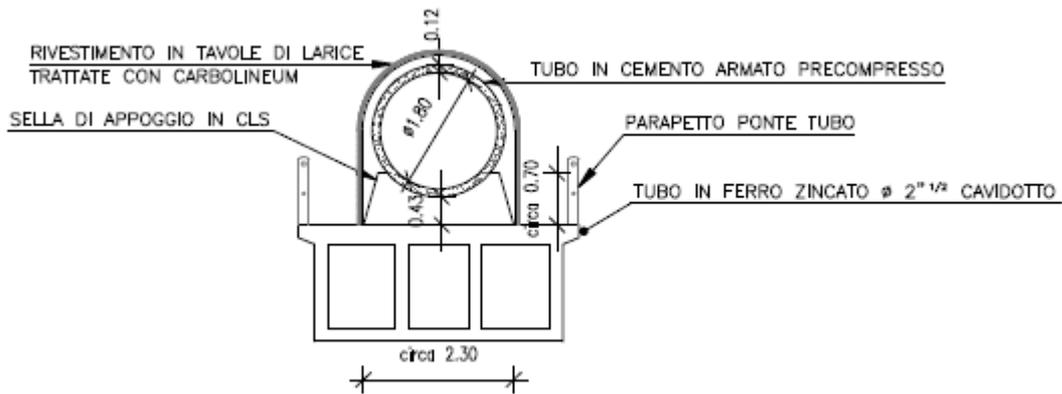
sezione in corrispondenza al ponte tubo della condotta forzata in c.a.p.
